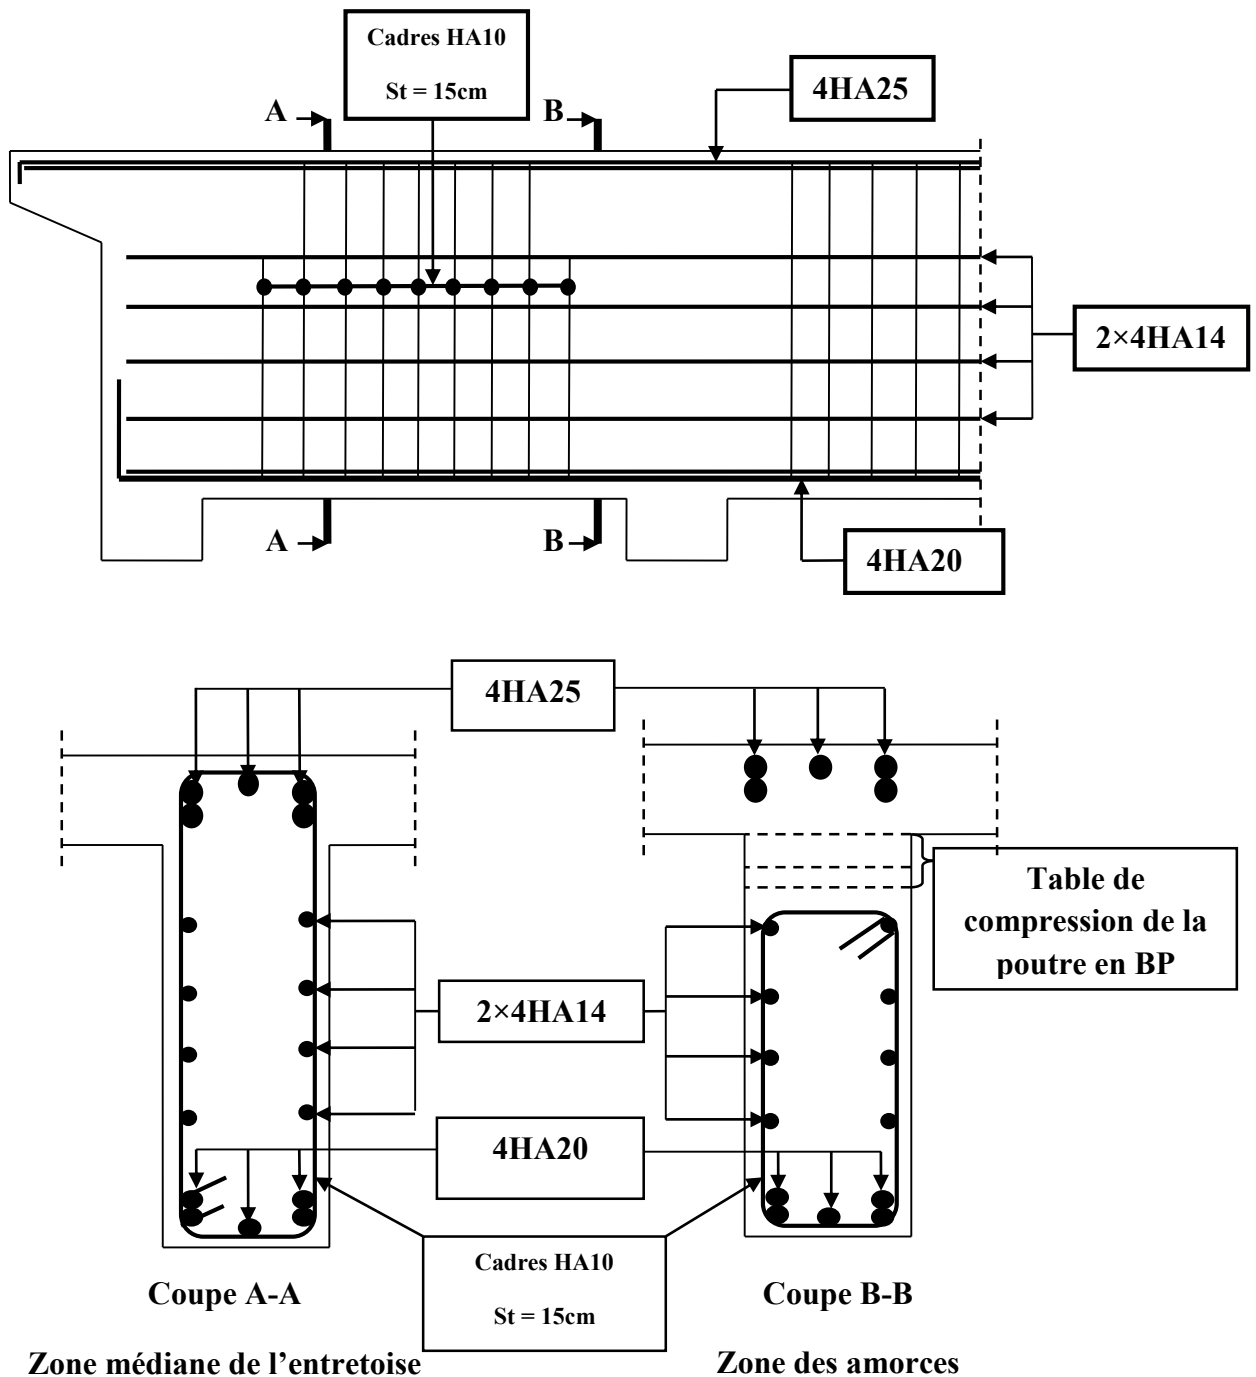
Schéma de ferrailage de l'entretoise.
